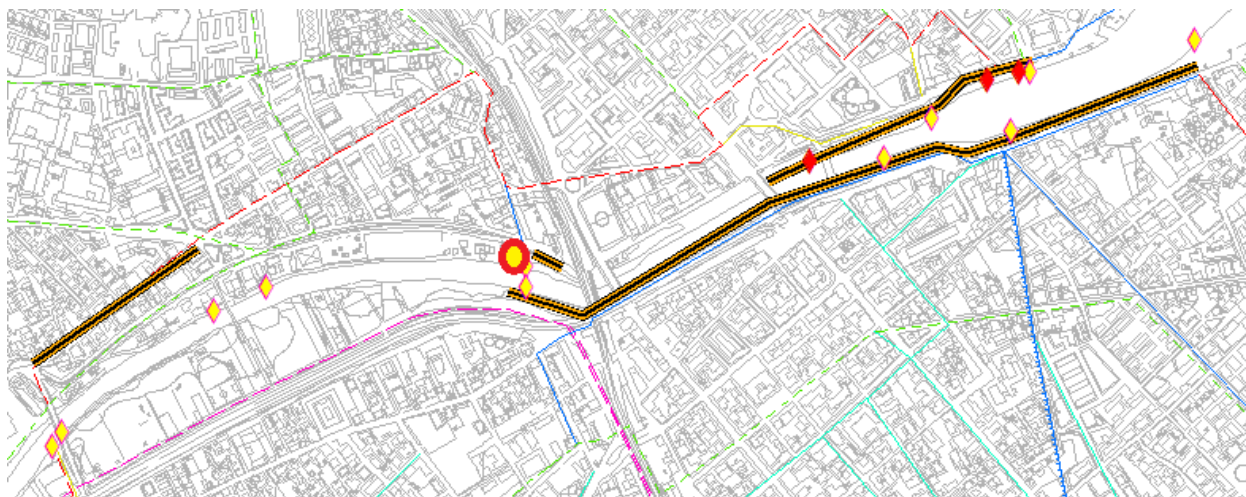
Planimetria con indicazione dei tratti di intervento previsti dal DK15.
